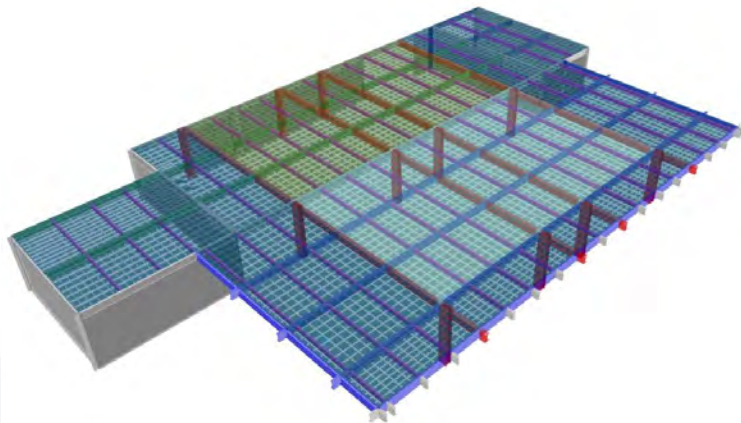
Vista isométrica con renderizado 3D de modelo con elementos tipo Shell. Fuente: Elaboración Propia
